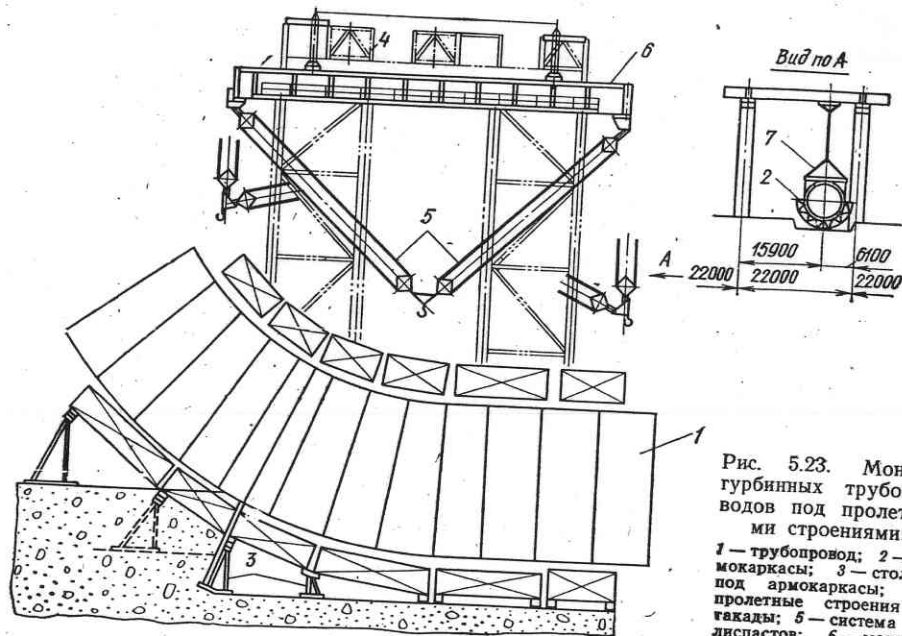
Монтаж гурбинных трубопроводов под пролетными строениями:
